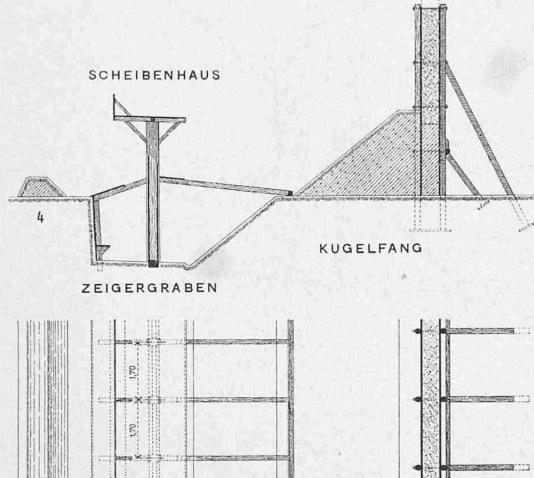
Schnitte und Grundriss vom Scheibenhaus und Kugelfang.
